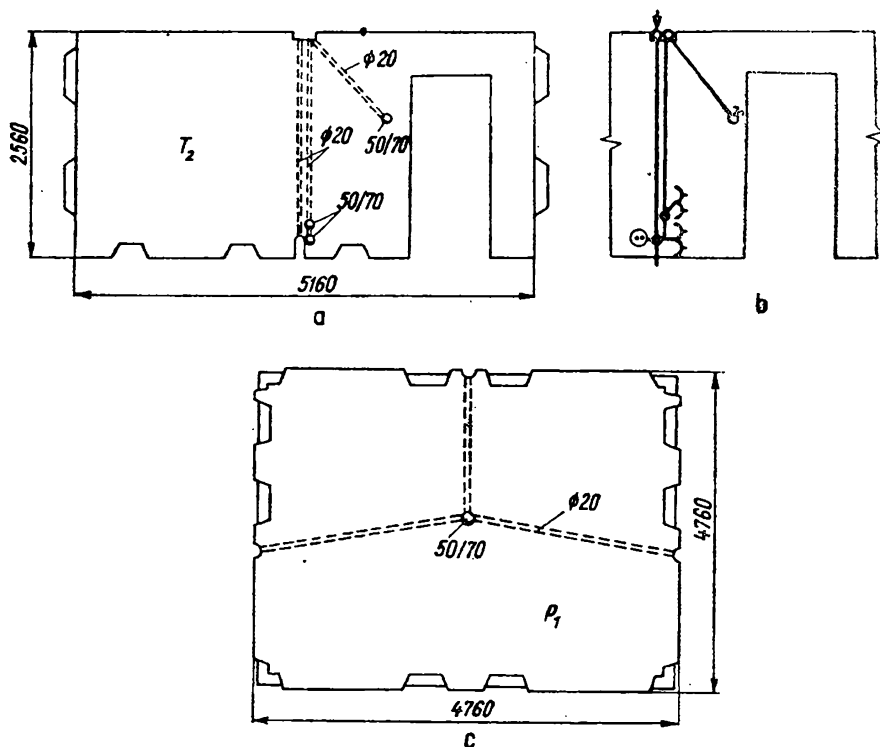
Exemple de panouri din beton armat cu goluri, sistem canalex, pentru instalații electrice (v. fig. 15-31):
